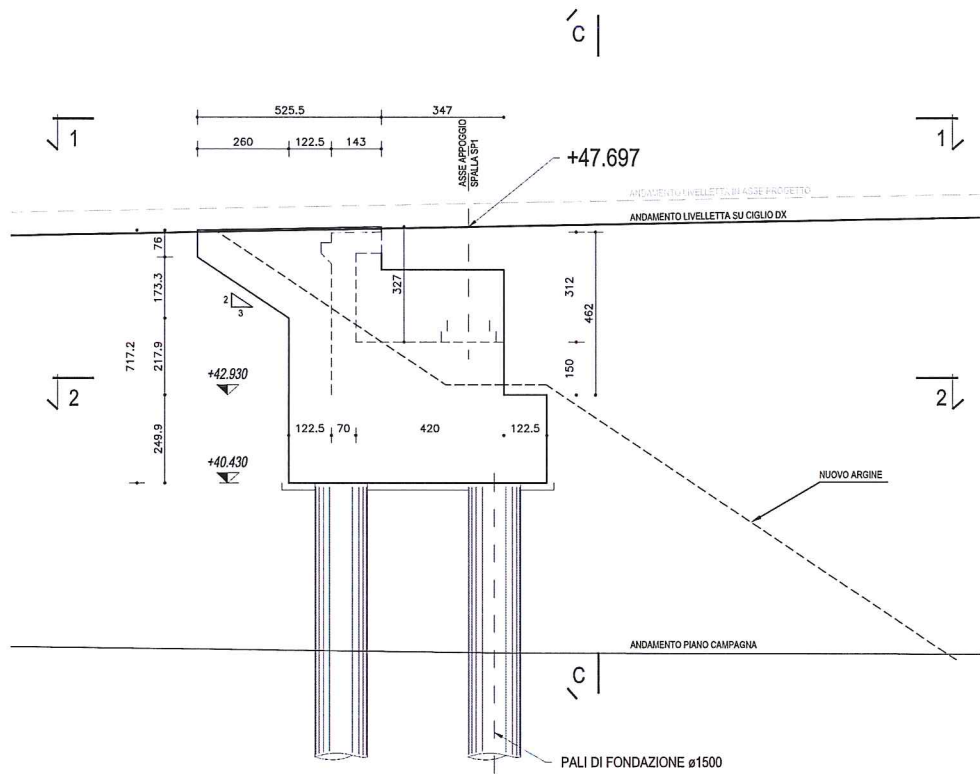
Vista laterale spalla (S1 NORD).
